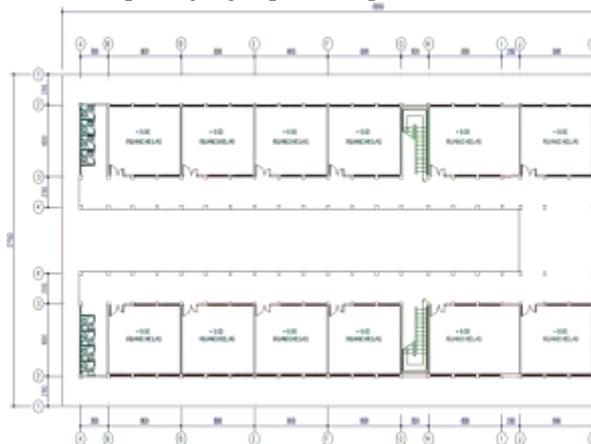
Denah Pengembangan Lantai 2 SD IT Al-Mawaddah sampai Tahun 2030
